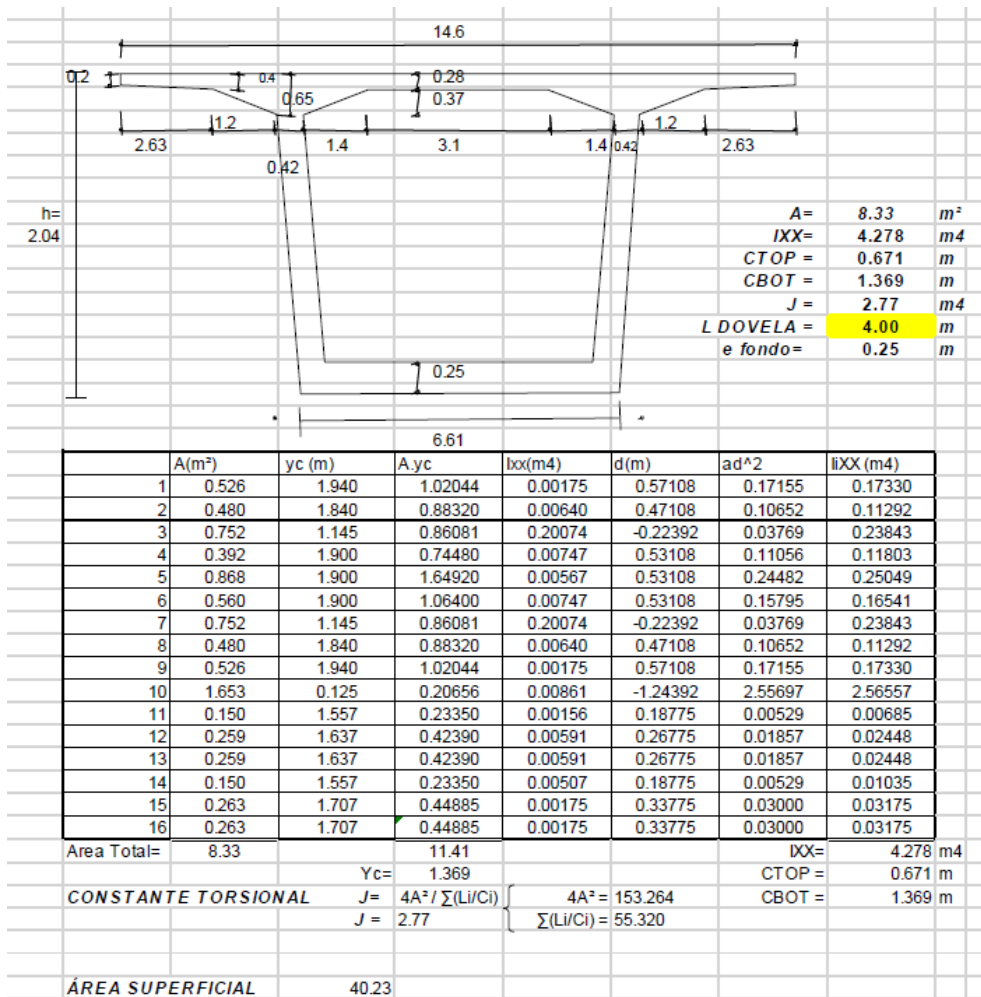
Dimensiones y propiedades de la viga cajón cara menor dovela 9 puente San Pedro.
